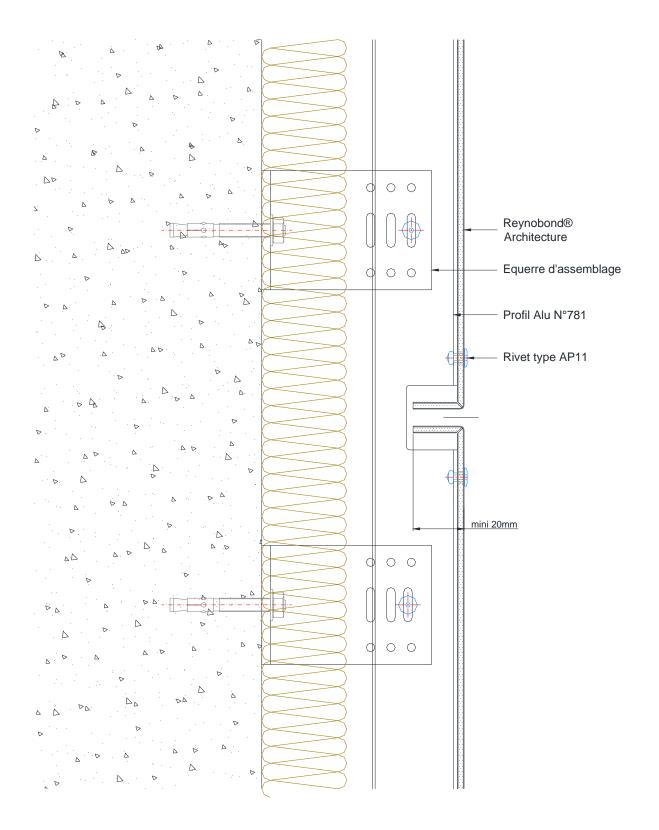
er- Joint horizontal - Coupe verticale - Système riveté RV 50 2c avec plis de renfort
